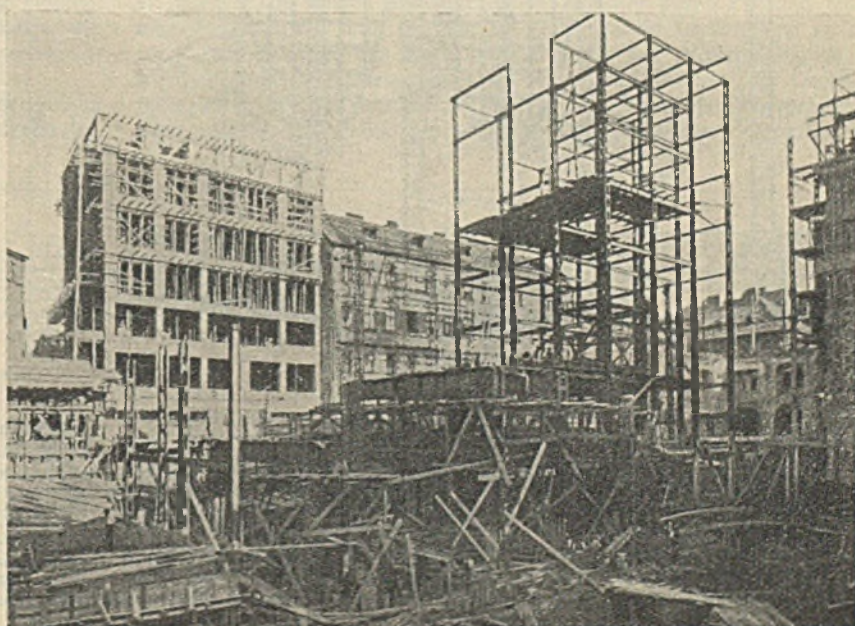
Aufbau des Stahlskeletts über dem Theatersaal.
